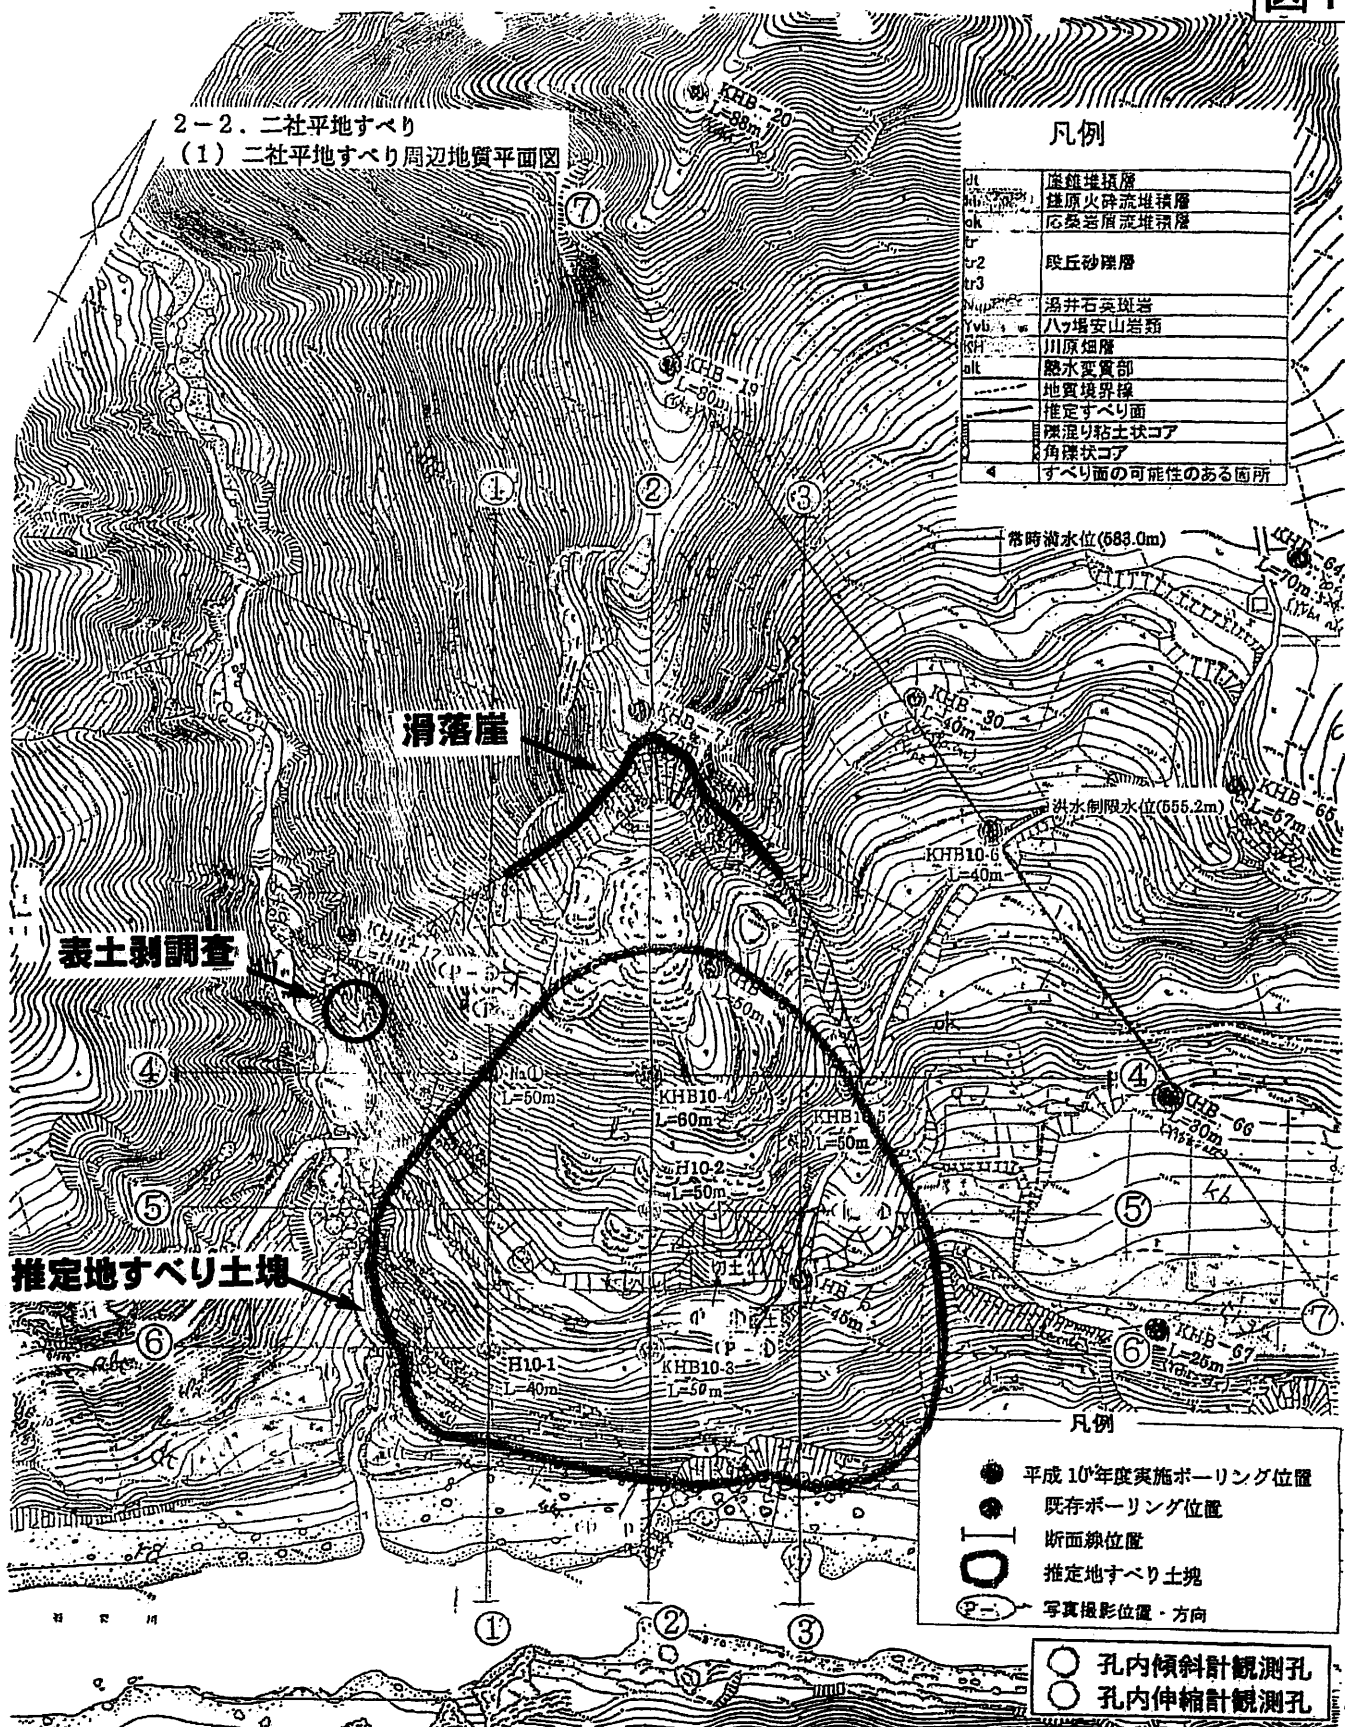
二社平地すべり周辺地質平面図 (S=1:1,000)
